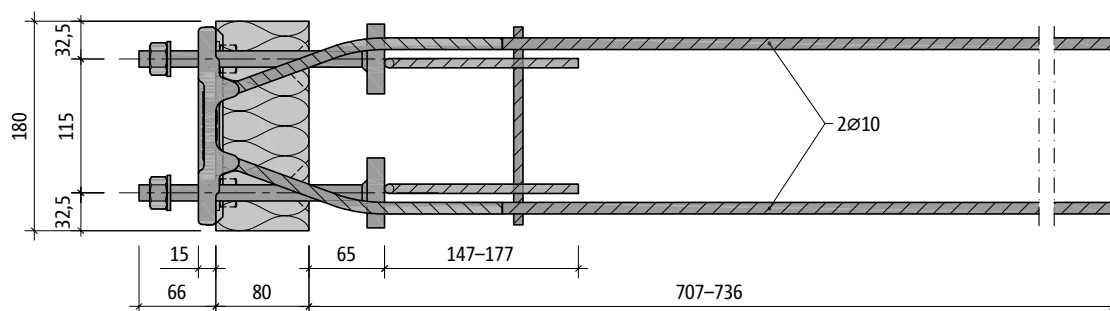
Schöck Isokorb® T type SQ-V2 : vue en plan
